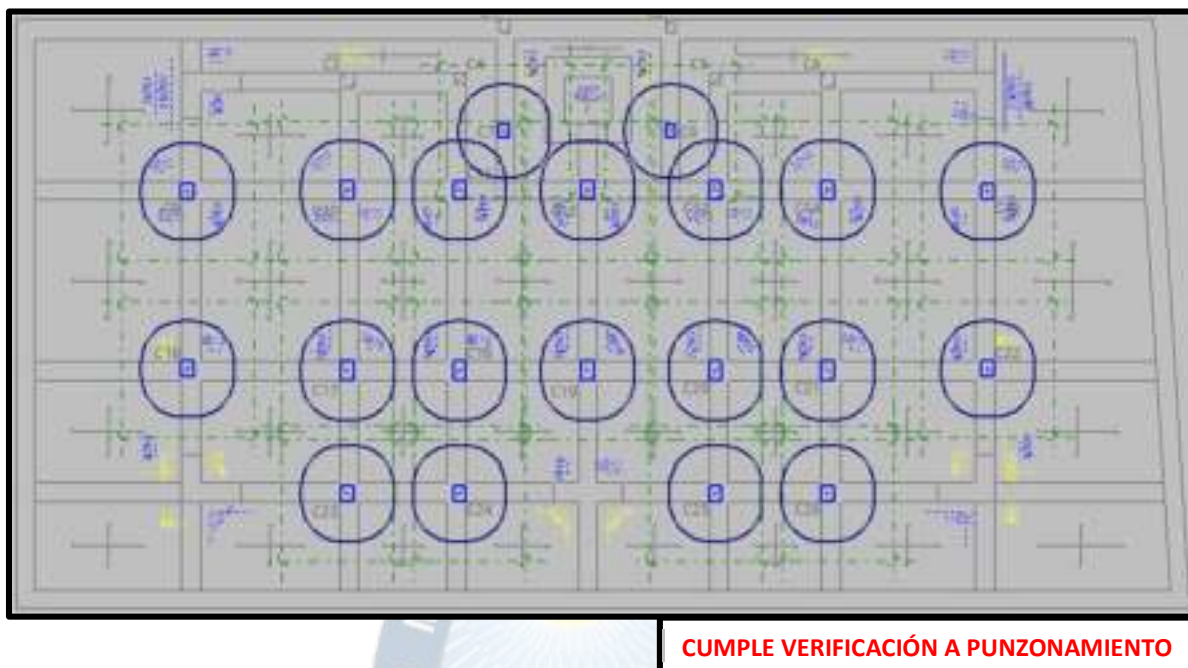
Verificación a Punzonamiento en la Losa de Cimentación s/ CBH – 87
